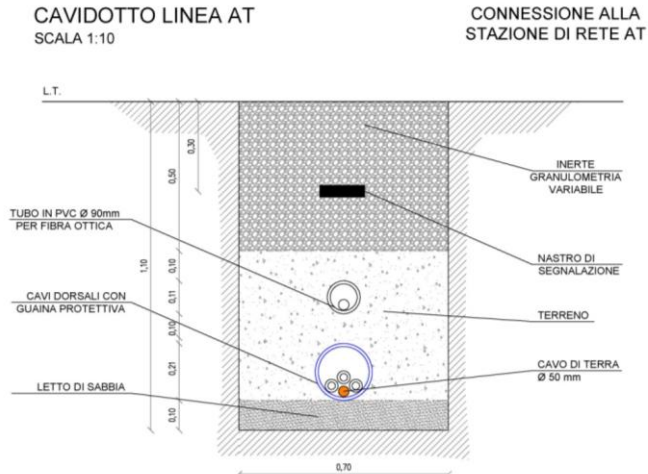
Sezione tipica di posa CEI 11-17 (cavidotto linea AT).
